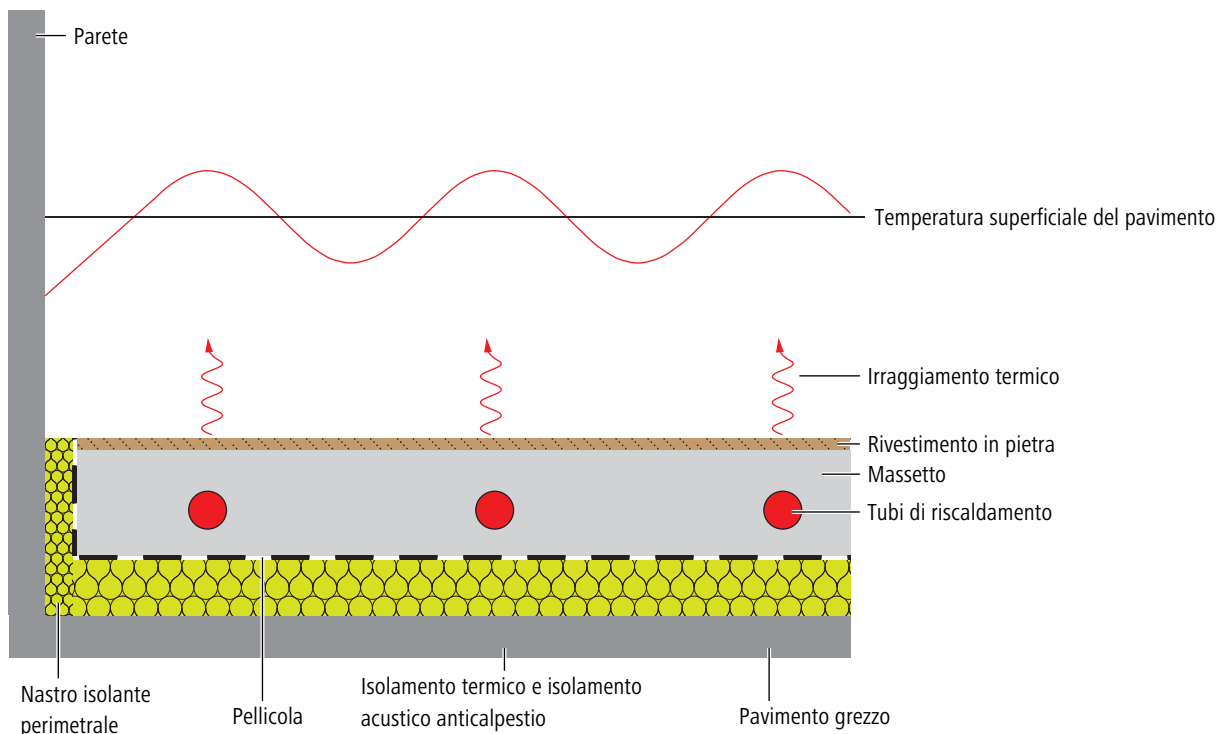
Posa a umido dell'impianto di riscaldamento a pavimento
